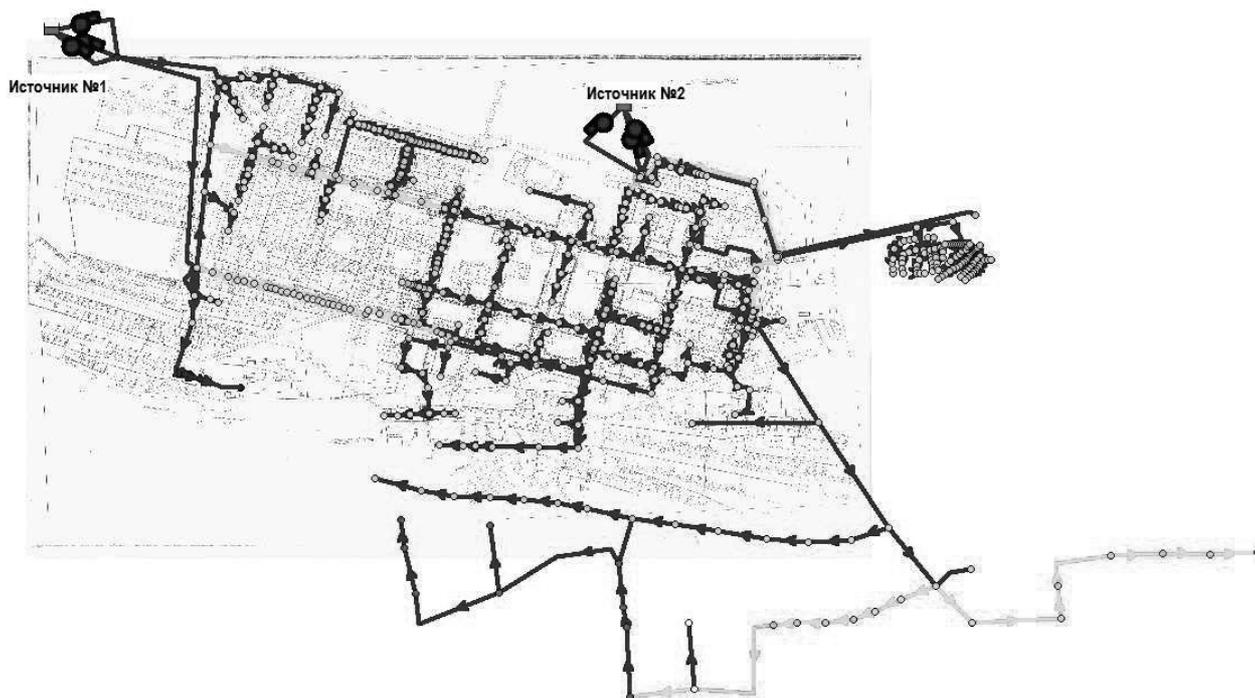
Расчетная схема сети водопровода п. Красногорский
